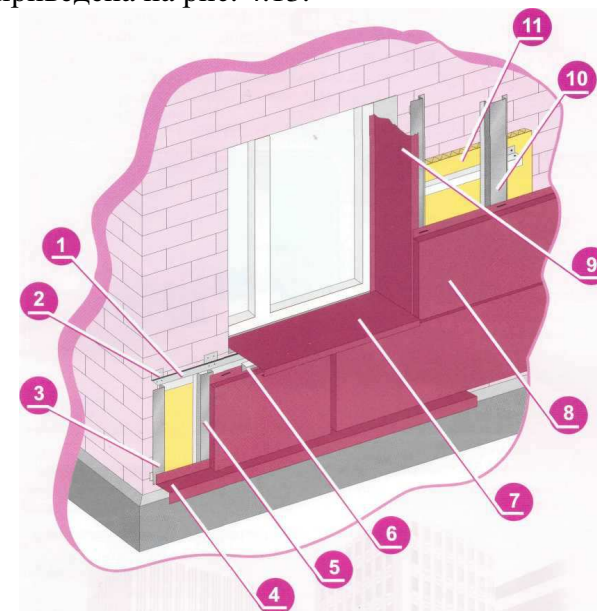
Технологическая схема монтажа металлической фасадной облицовки
